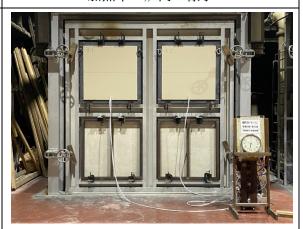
試験体 3-1,3-2 非加熱面・放冷終了時(390分)
